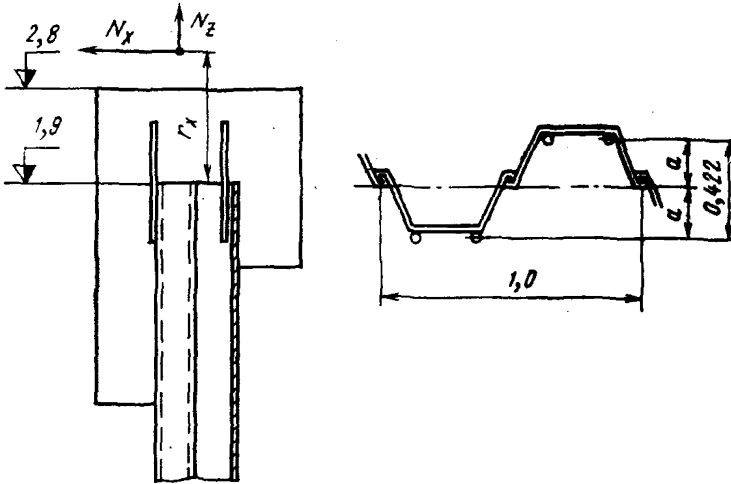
Расчетная схема к определению количества арматурных стержней, передающих усилия от тумбового массива на шпунт
